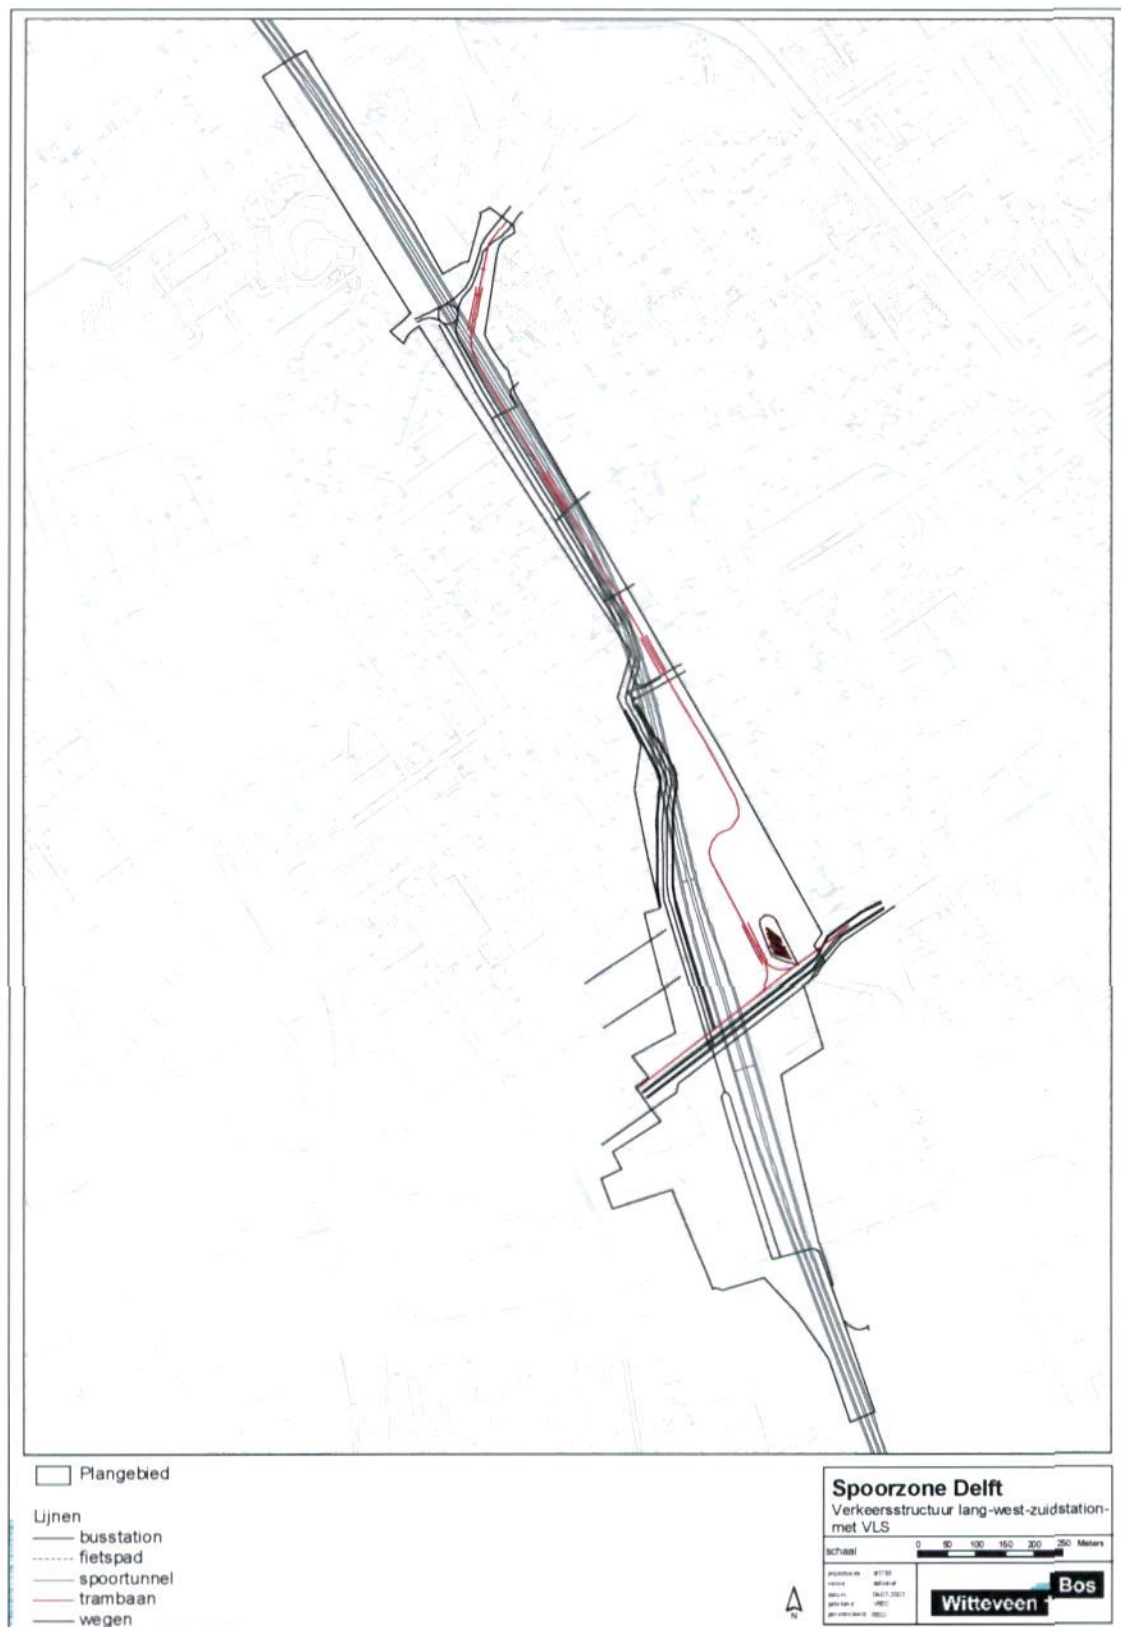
LWZ: Lange tunnel, westelijk tracé en zuidelijk gepositioneerd station
